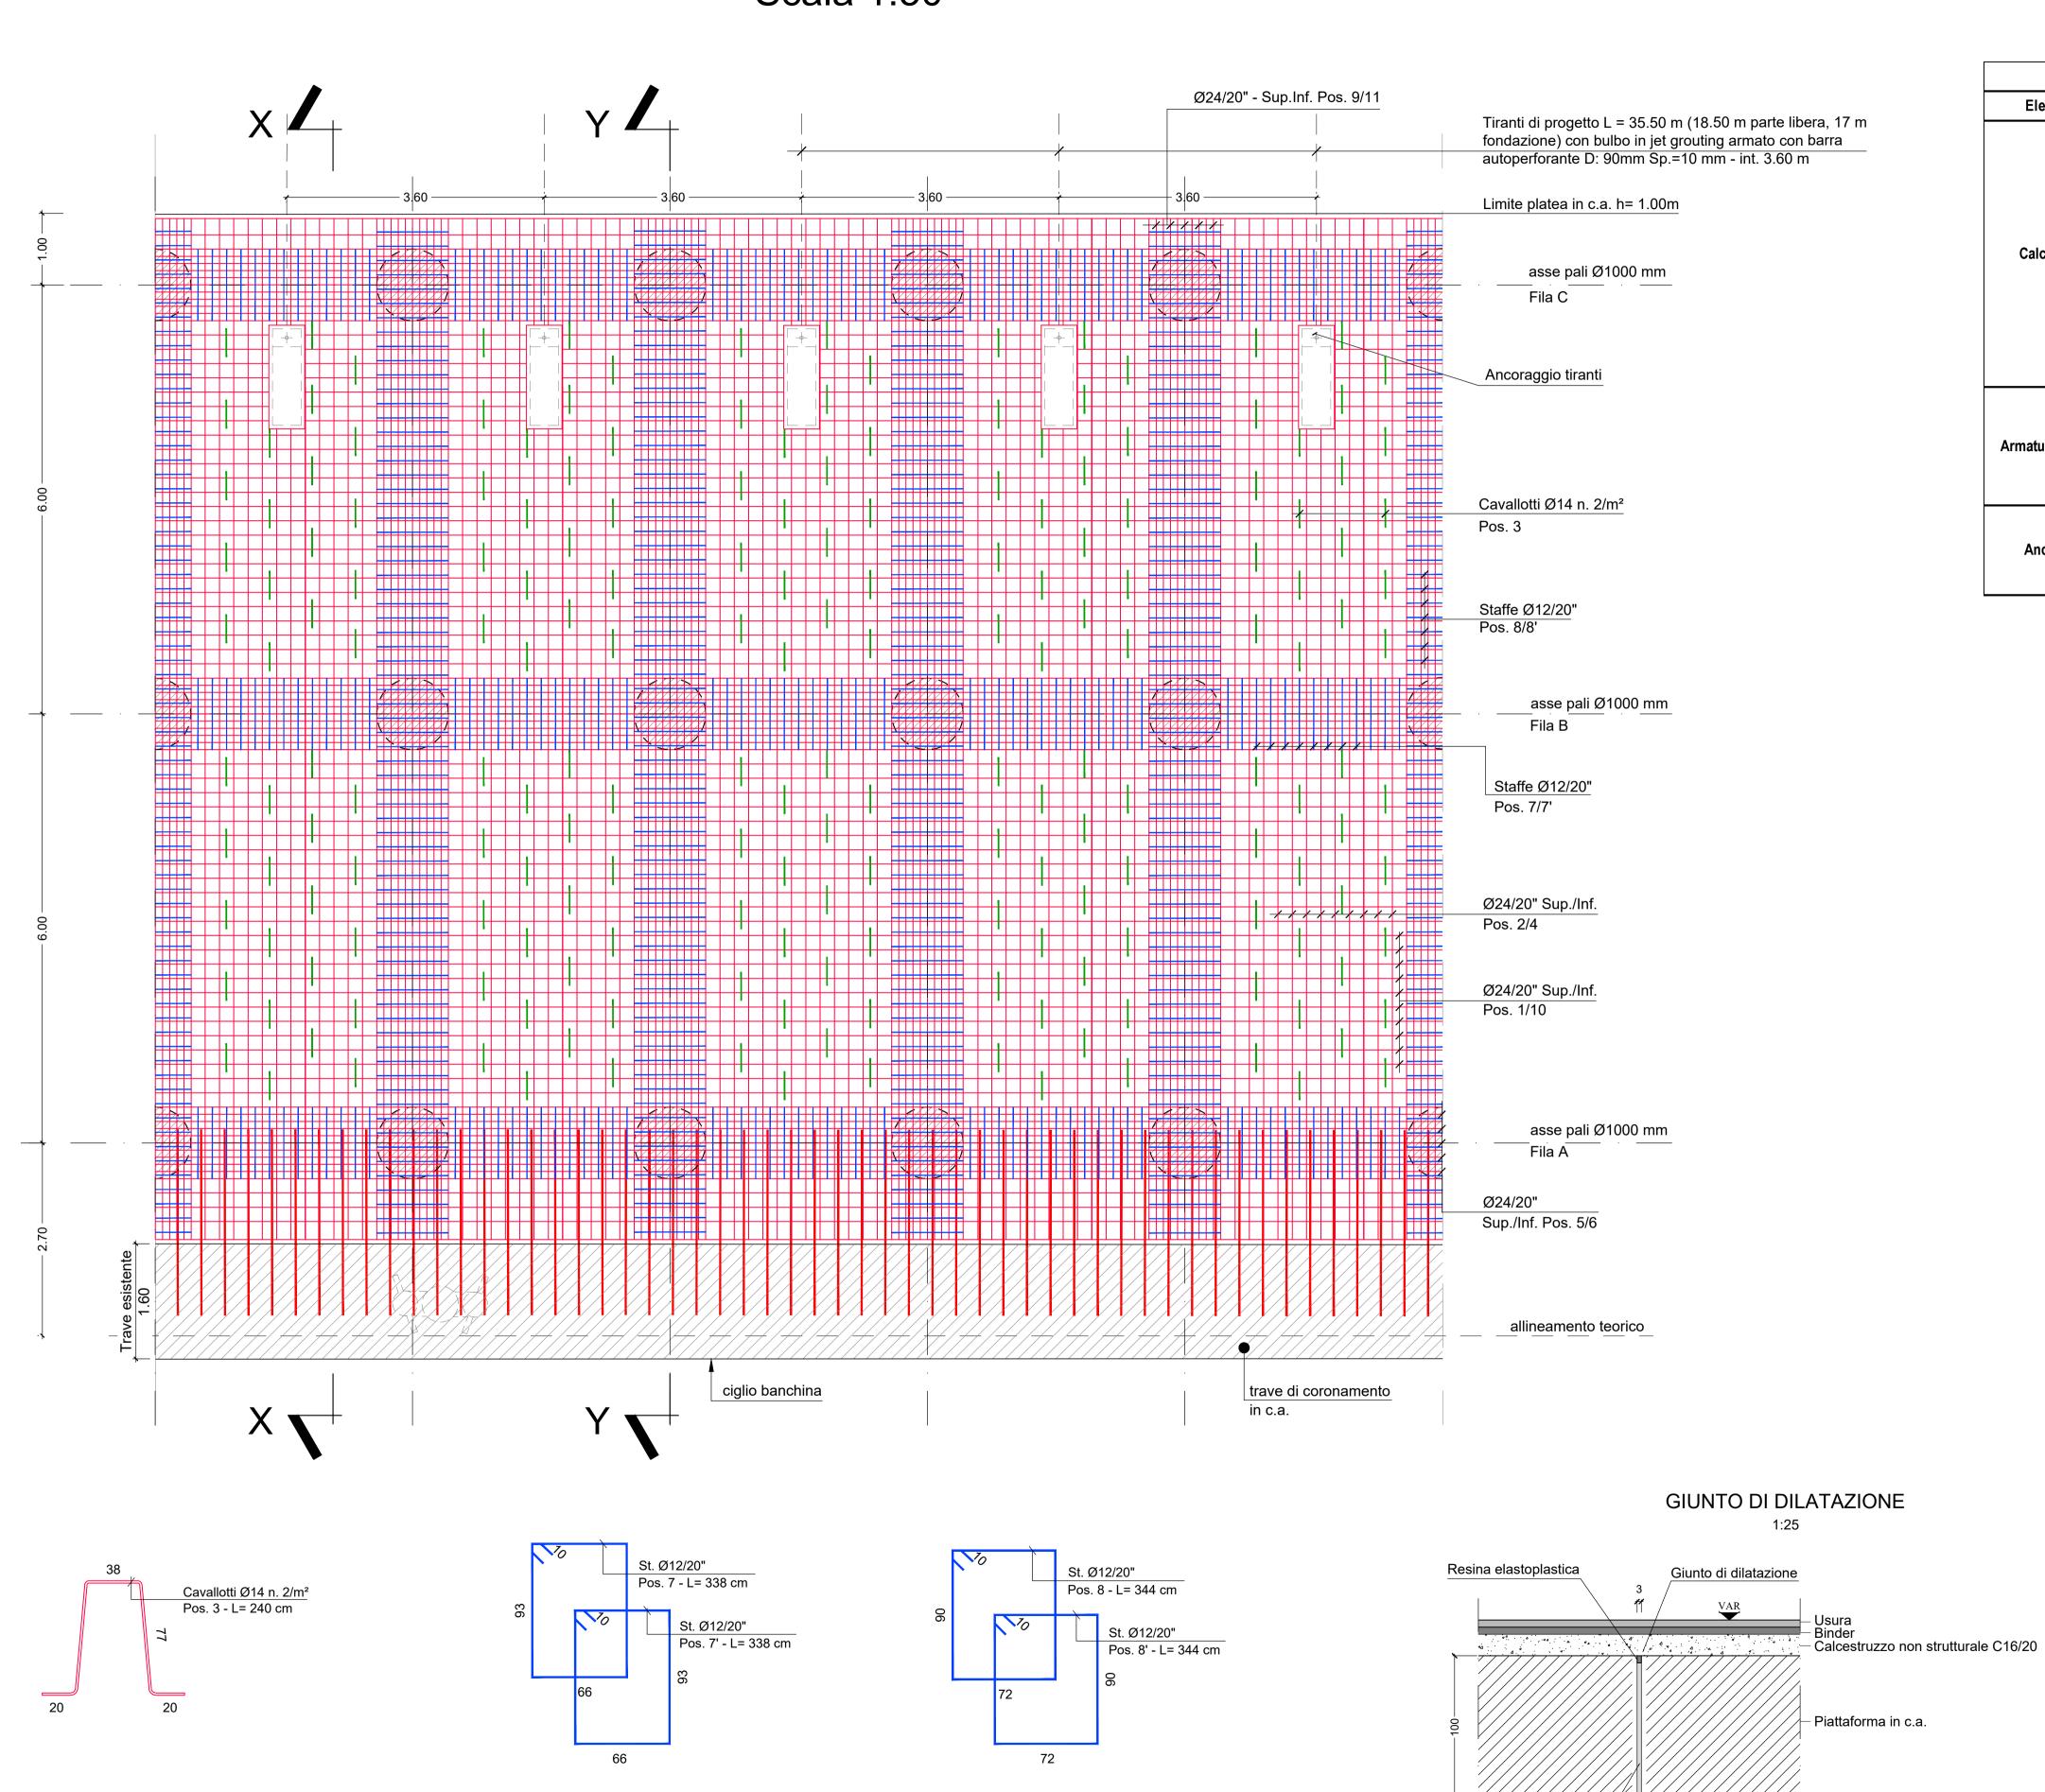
PLATEA IN C.A. STRALCIO PIANTA ARMATURA
